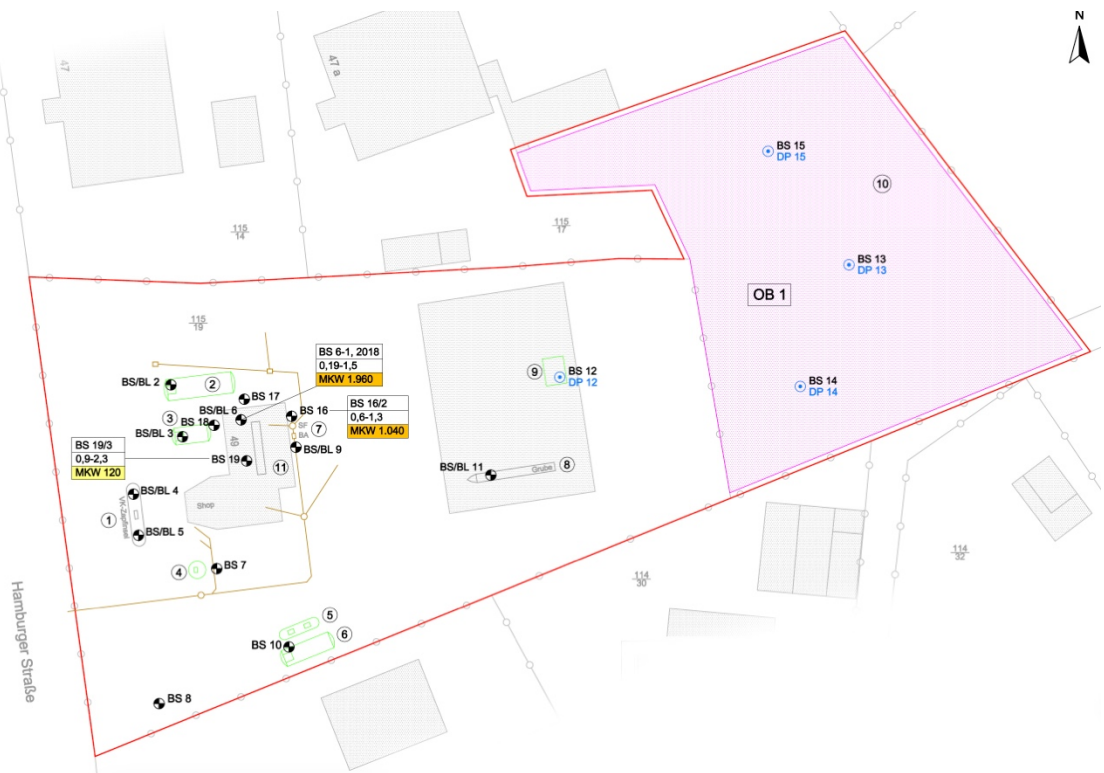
Lageplan mit Untersuchungsgrundstück / Altstandort (siehe rote Umrandungslinie),
